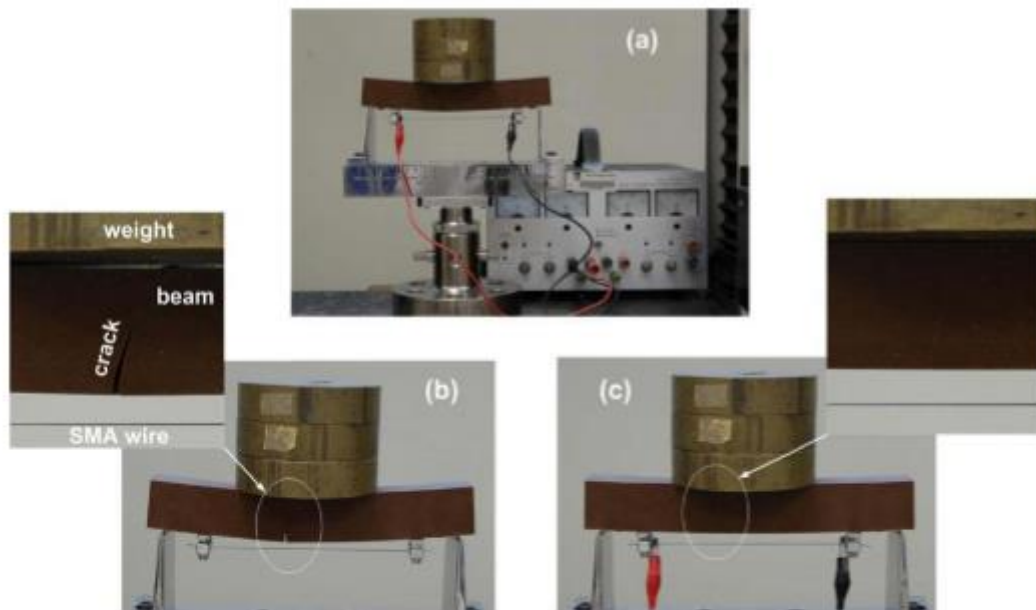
Fermeture de fissure d'une poutrelle en flexion trois points par activation thermique d'un fil AMF disposé à l'extérieur de la poutre. (Waibaye, 2016)
